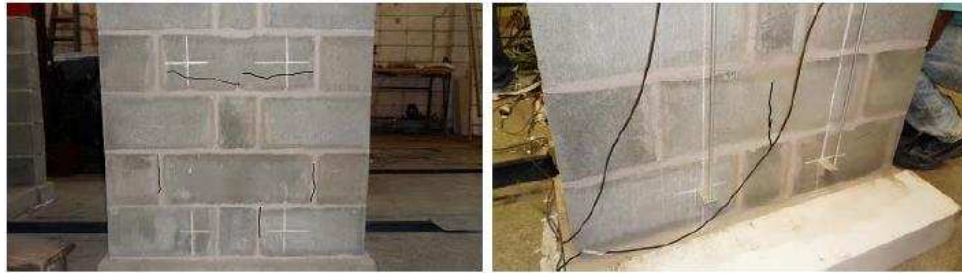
Padrão de fissuração dos flanges.
